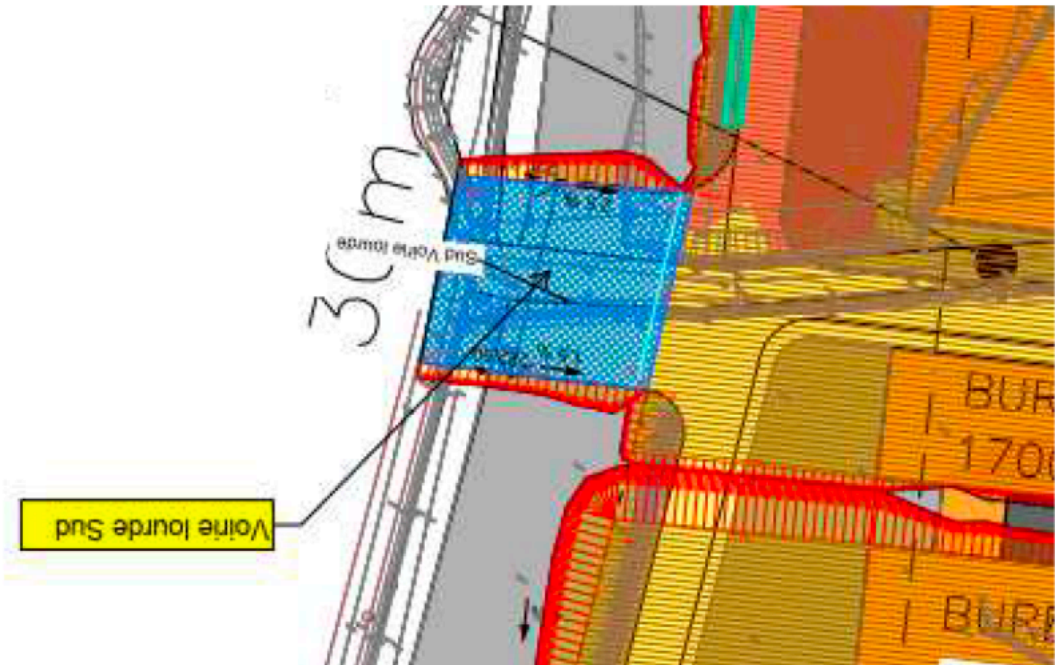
Extrait de plan de la modélisation de la plateforme routière : accès voirie de l’extension Sud (SOURCE : MÉMOIRE TECHNIQUE OTE JUIN 2024)
